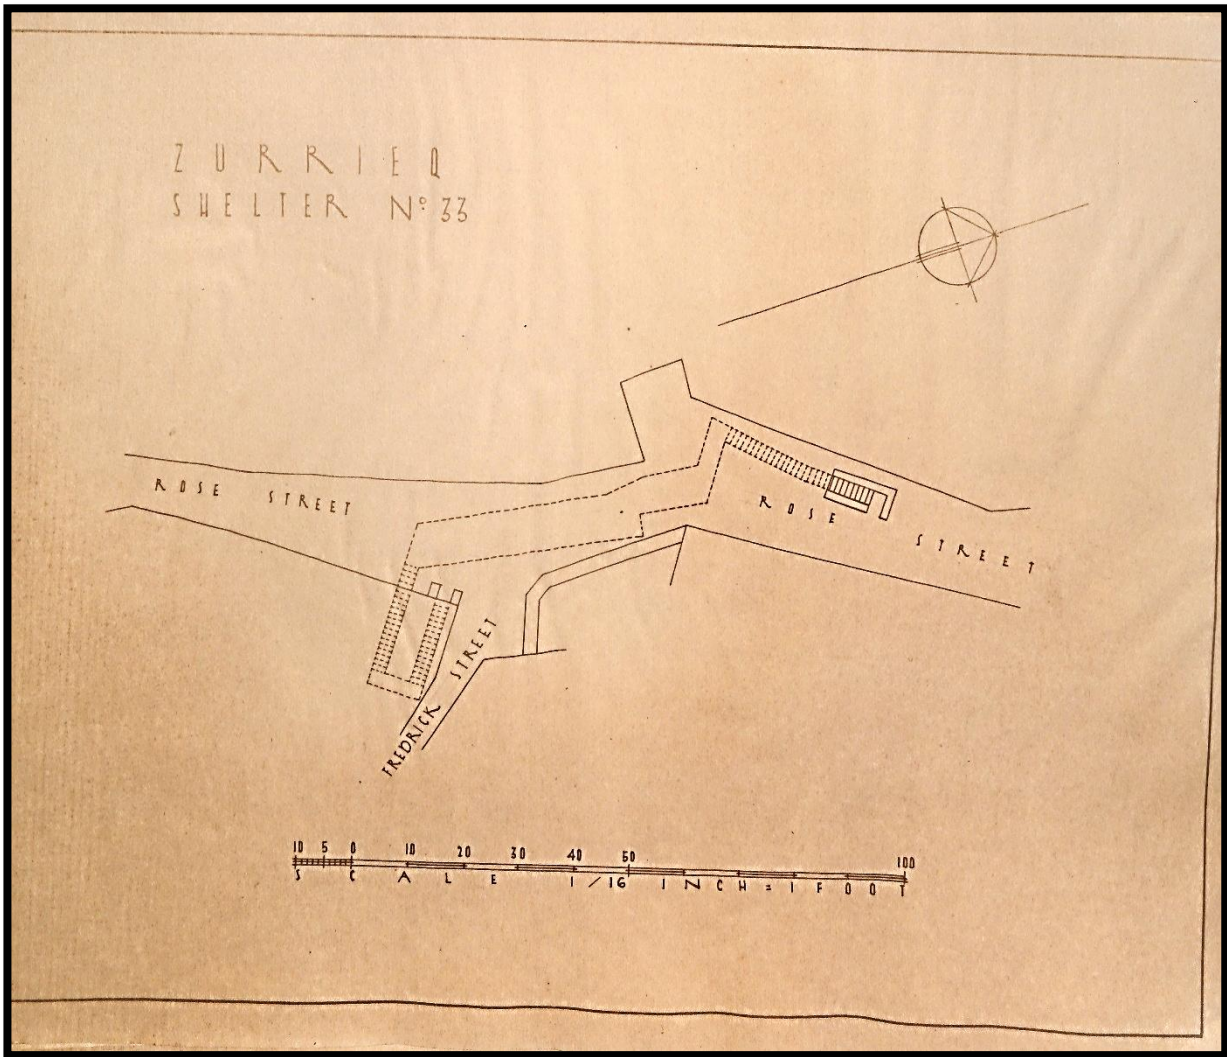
Planta do Abrigo nº33 "Rose Street - Fredrick Street"
